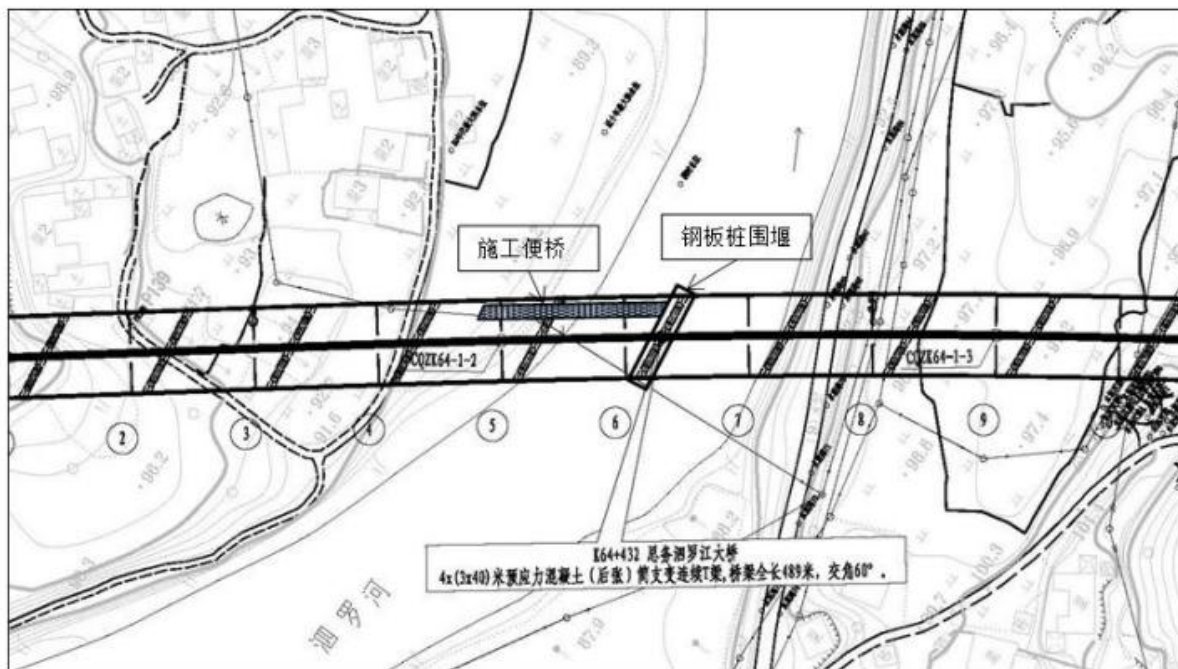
思务泗罗江大桥 6#桥墩钢板桩围堰施工平面图
